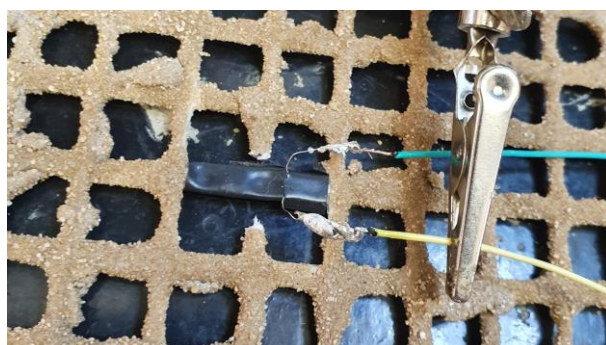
Ponte de ligação entre o extensômetro e o cabo de dados (Fonte: Autor)
